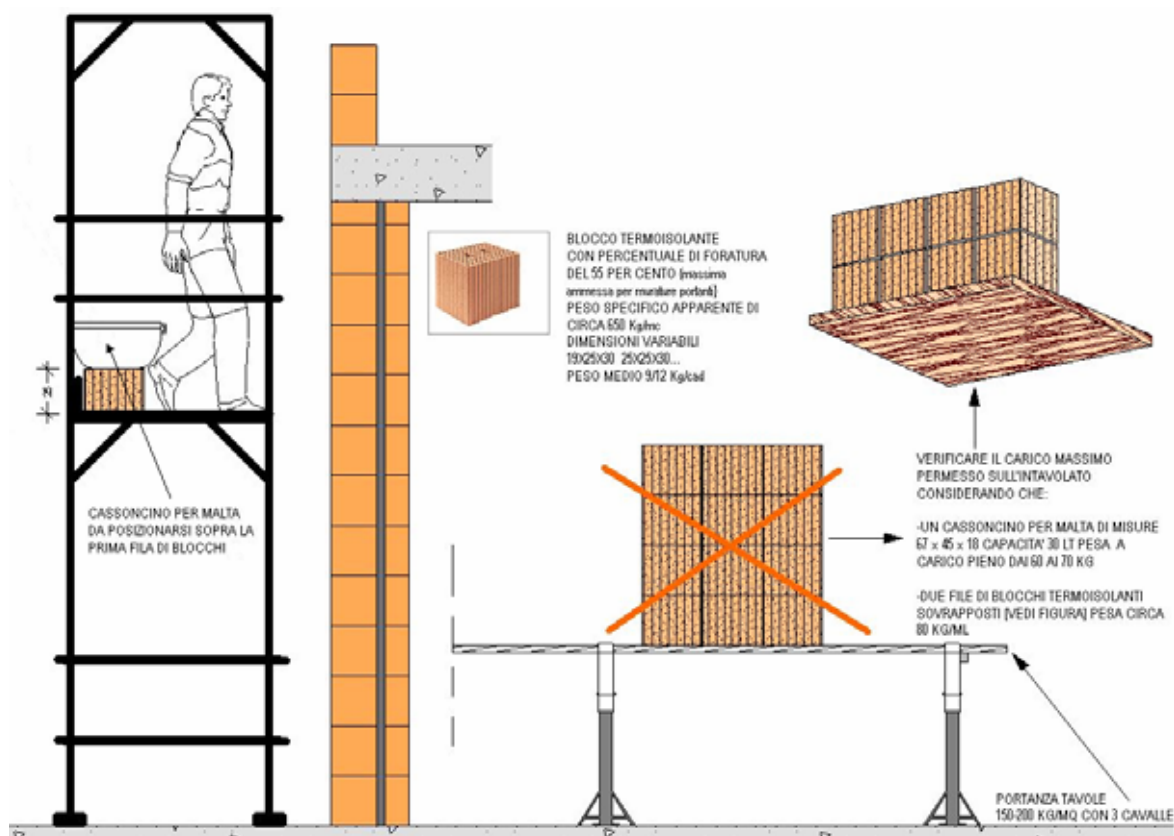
Particolare. Sovraccarico sull'intavolato del ponteggio e del ponte su cavalletti
